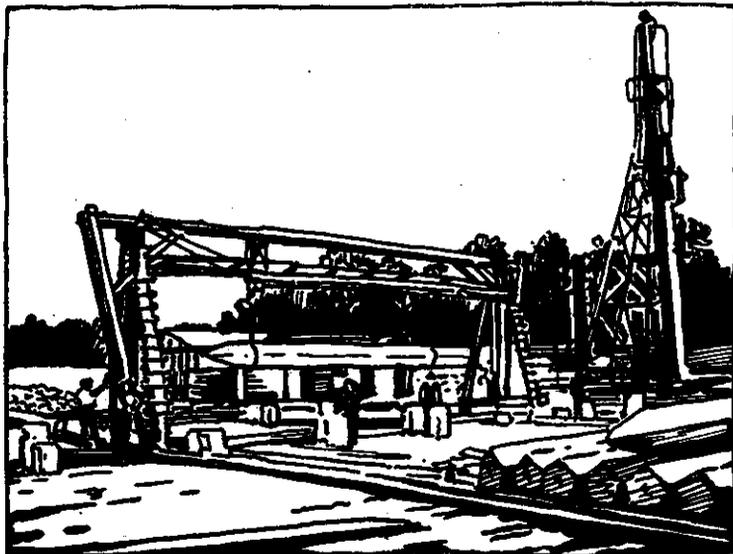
По мере надобности может производиться наращивание железобетонных свай или их укорочение.
